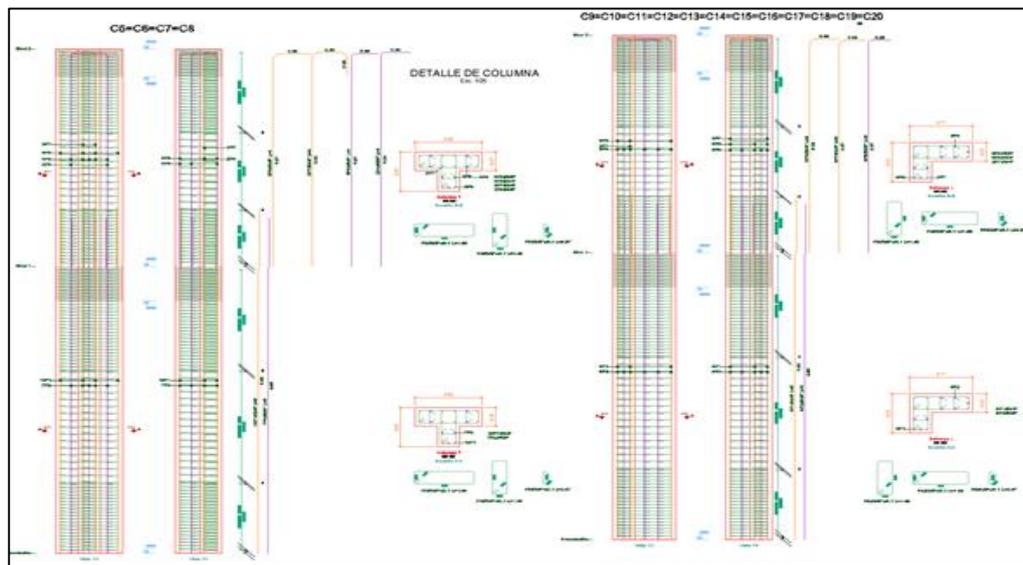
COLUMNAS L Y T MODULO I
